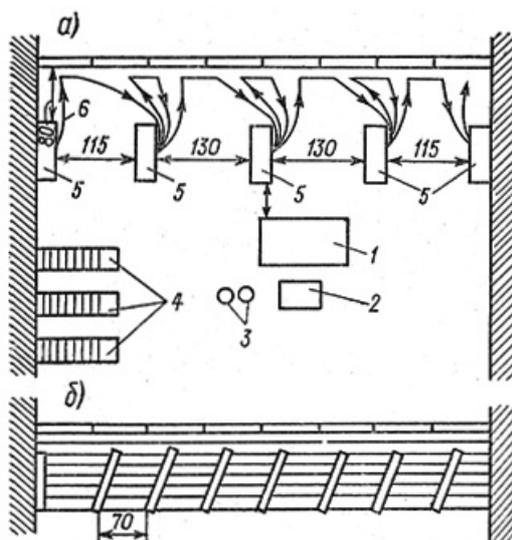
Схема организации рабочего места при устройстве одной перегородки
